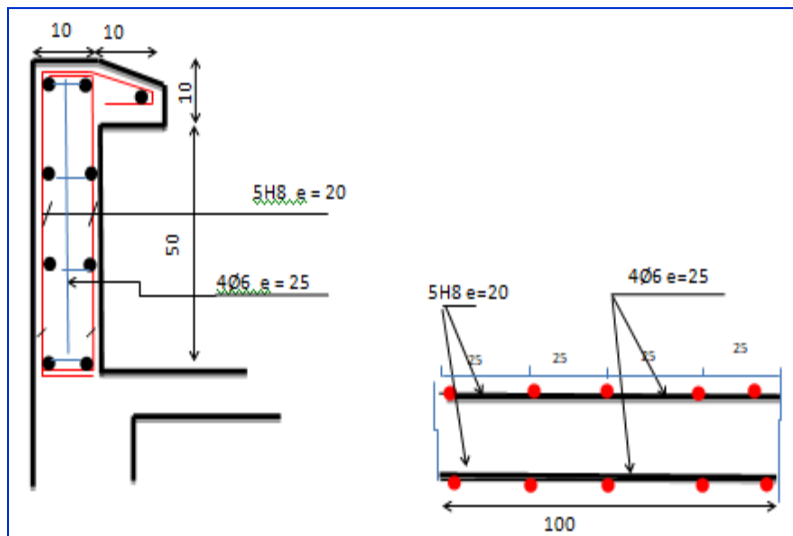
Schéma ferrailage de l'acrotère
